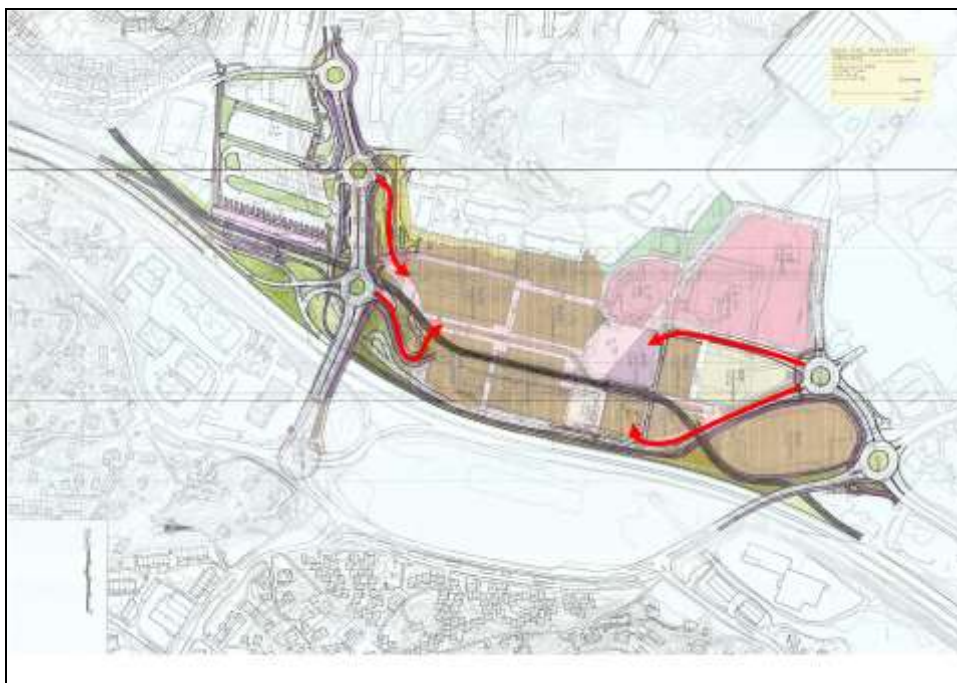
Endring i trafikkmengde ved nytt planforslag (alt.1) sammenlignet med gjeldende plan (Alt. 0).
